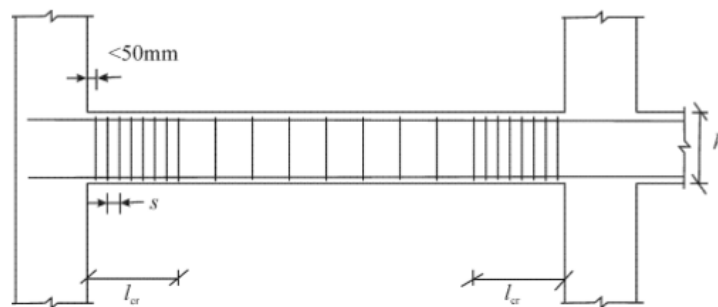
Armaduras Transversais nas zonas críticas das vigas
